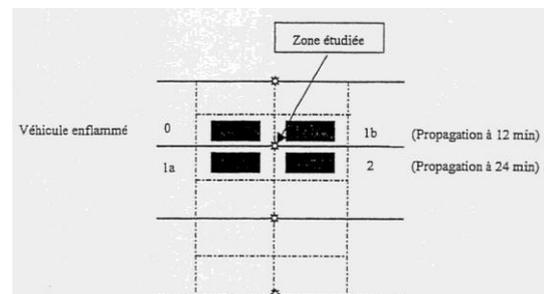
Layout e schema delle strutture di acciaio di un'autorimessa di tipo aerato
